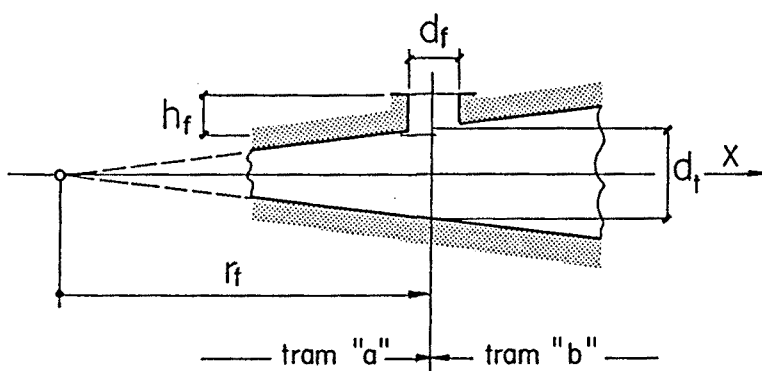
Dimensions d'un forat obert en un tub cònic.
